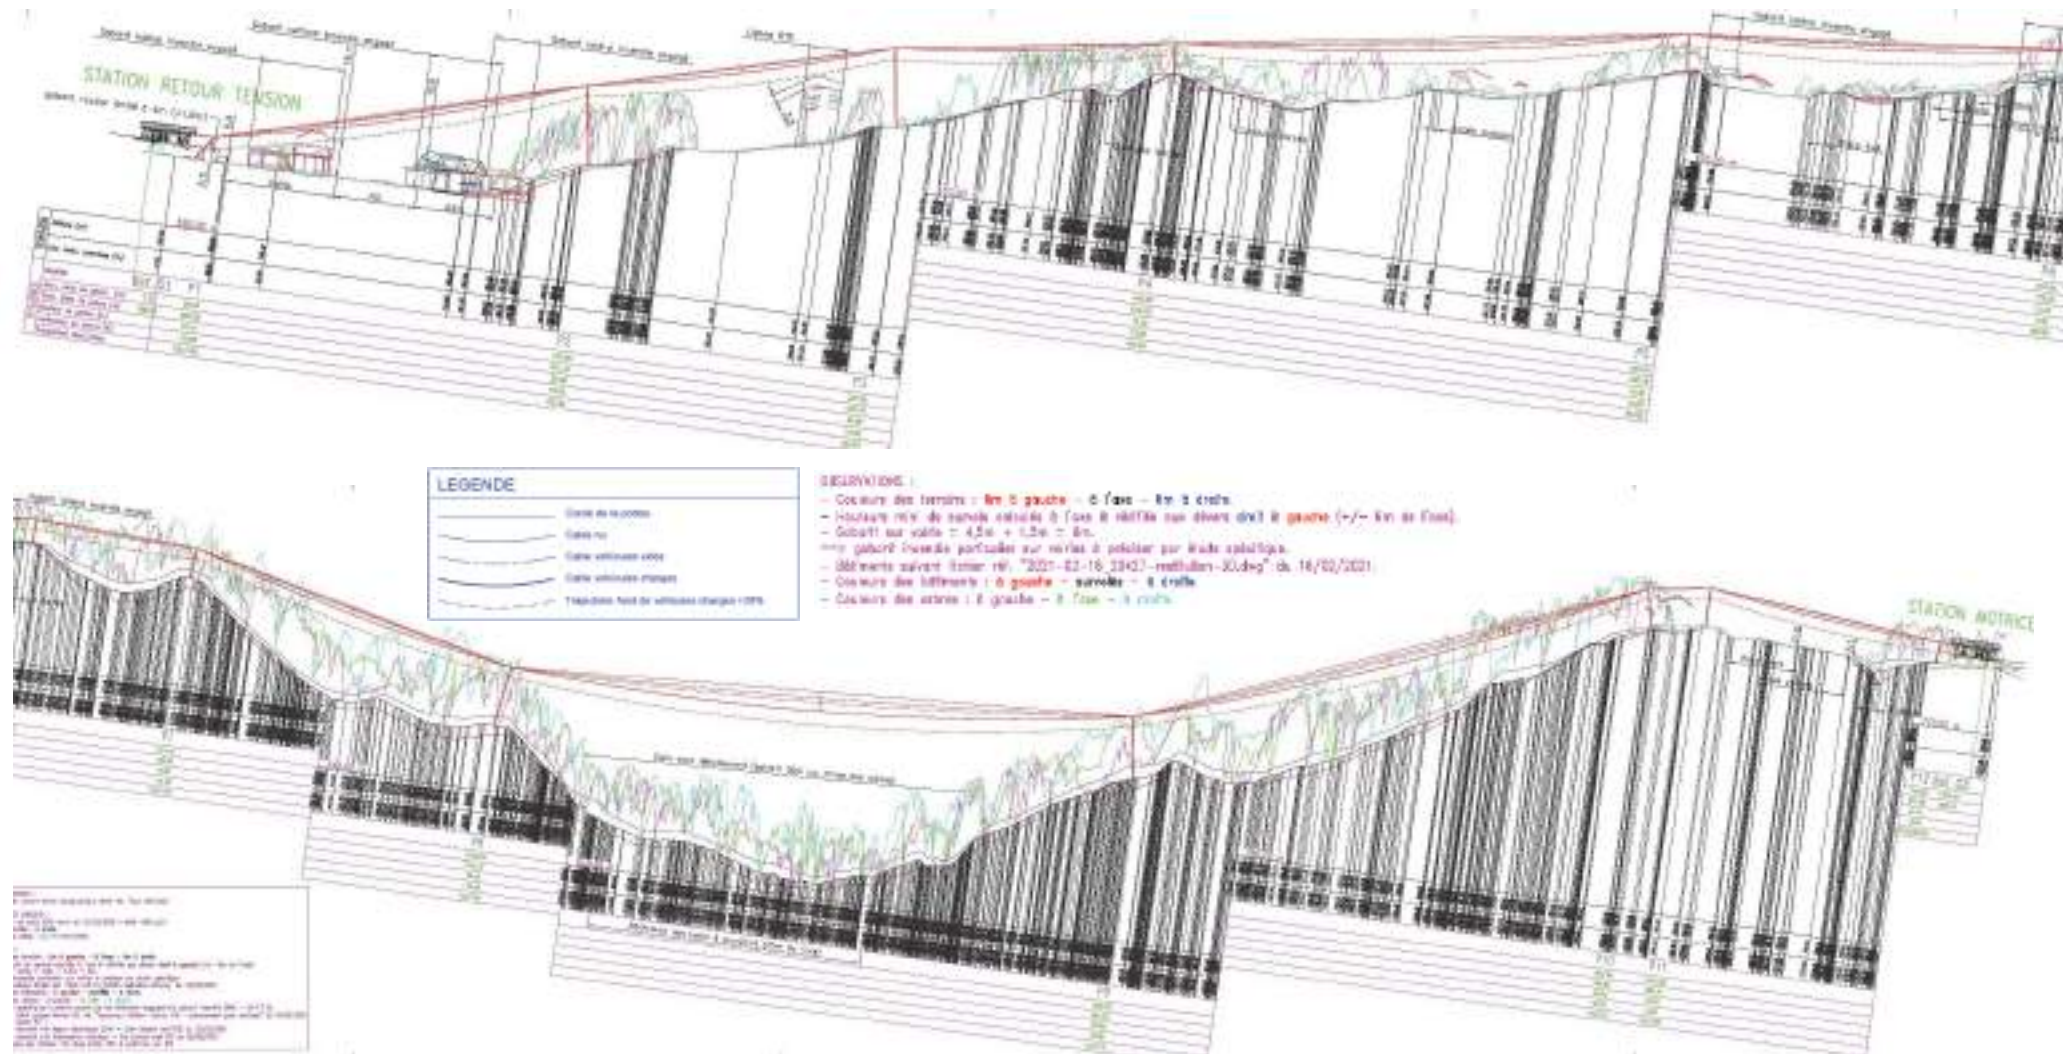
Profil en travers du projet retenu (source DCSA – STBMA – 15/12/2021)
